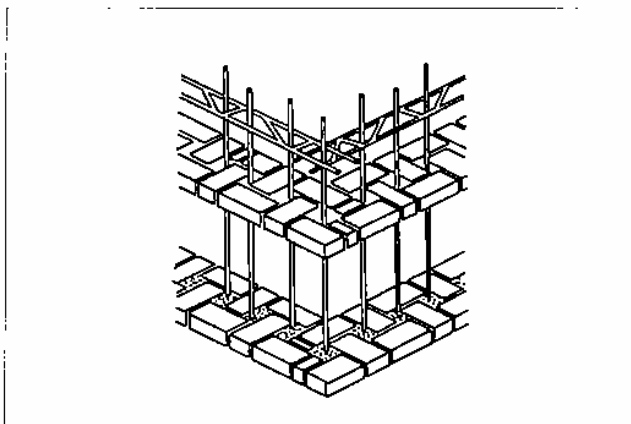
Appareillage permettant la pose d'armatures verticales.
